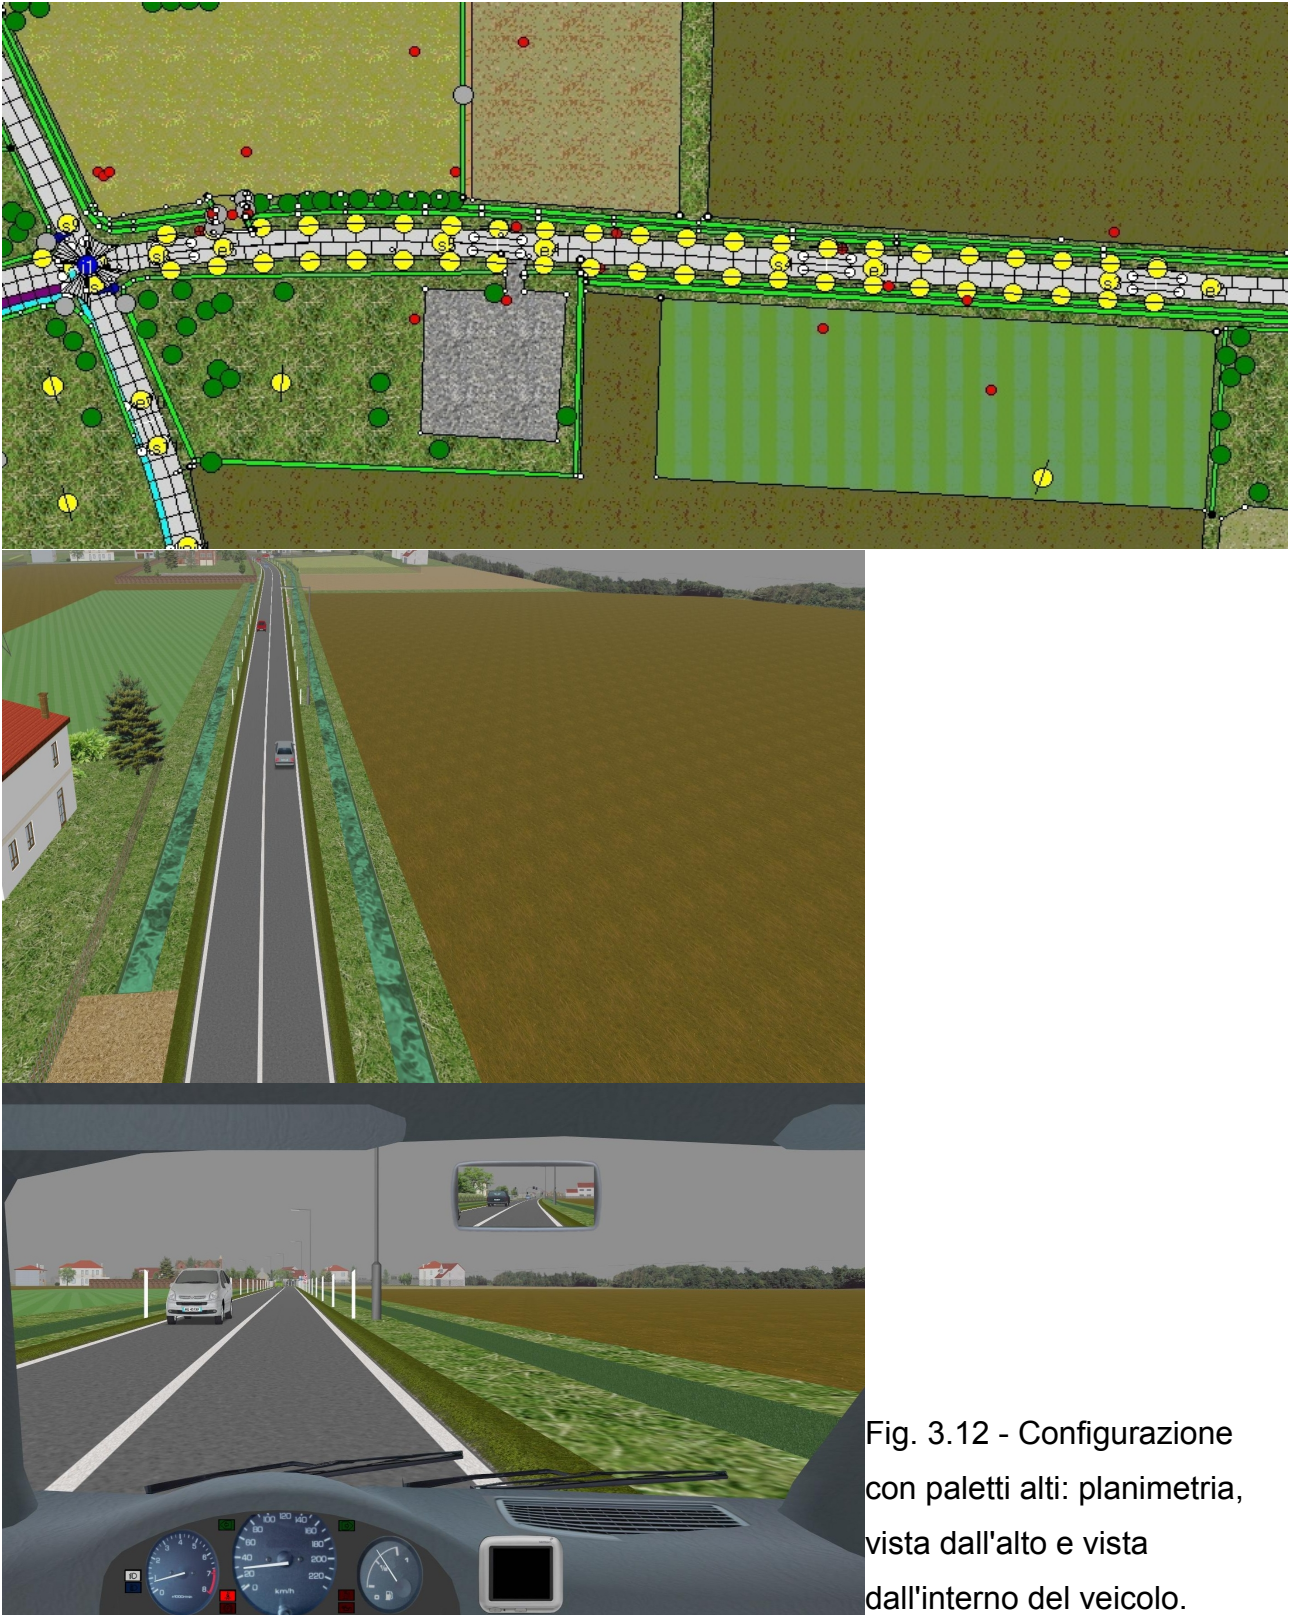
Configurazione con paletti alti: planimetria, vista dall'alto e vista dall'interno del veicolo.
